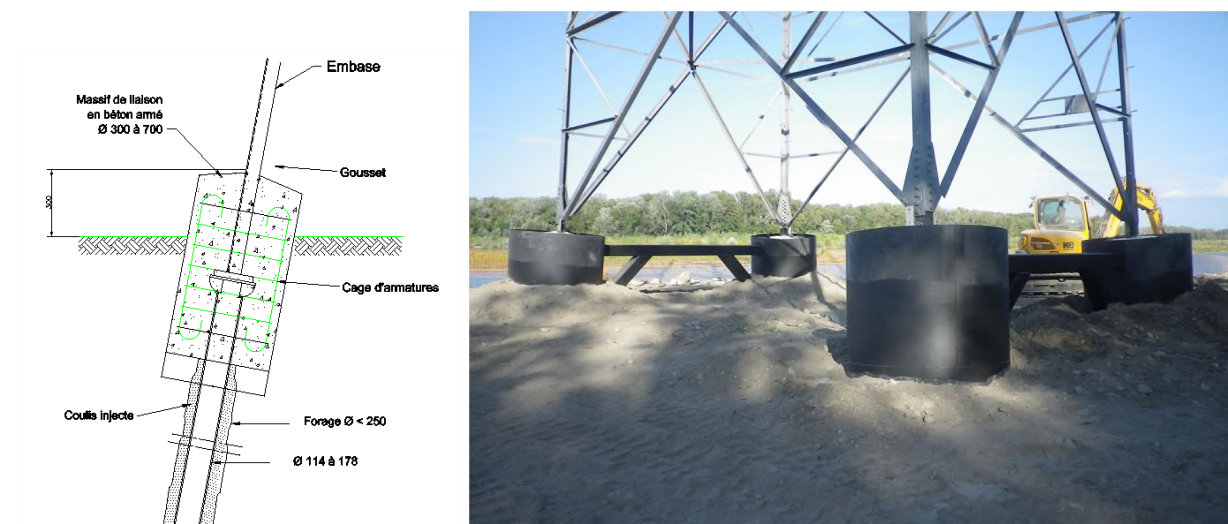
Schéma type de la partie enterrée d'une fondation spéciale
